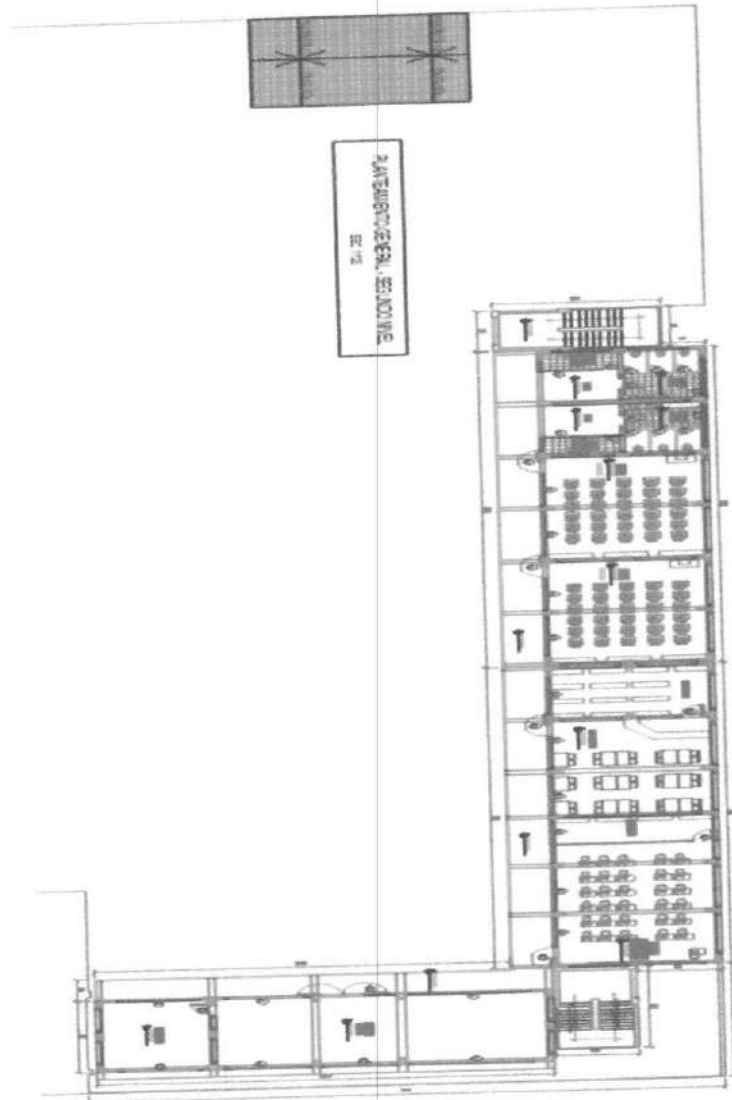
Planta Arquitectónica Proyectada - 2° Nivel
